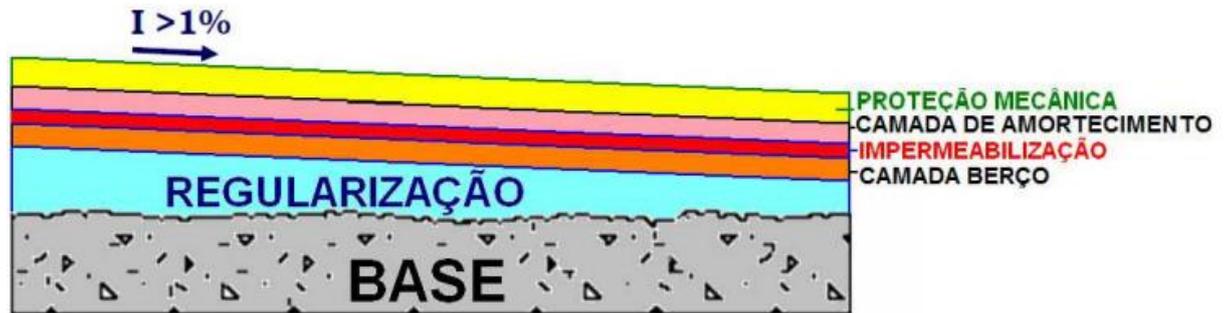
Camadas que compõem o sistema de impermeabilização (CUNHA, 2021).
